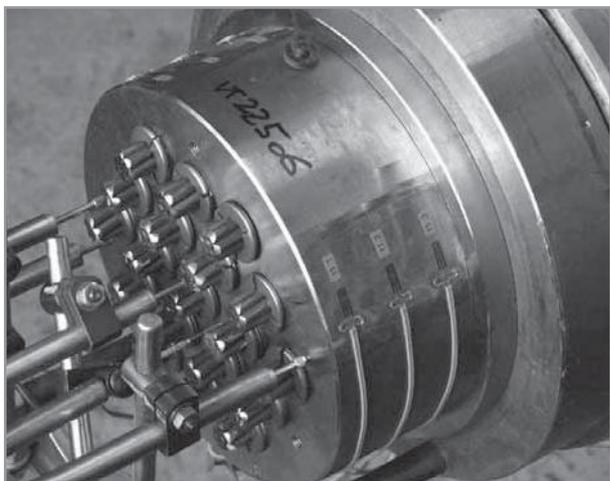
Detalle de la instrumentación del anclaje durante ensayo estático.
